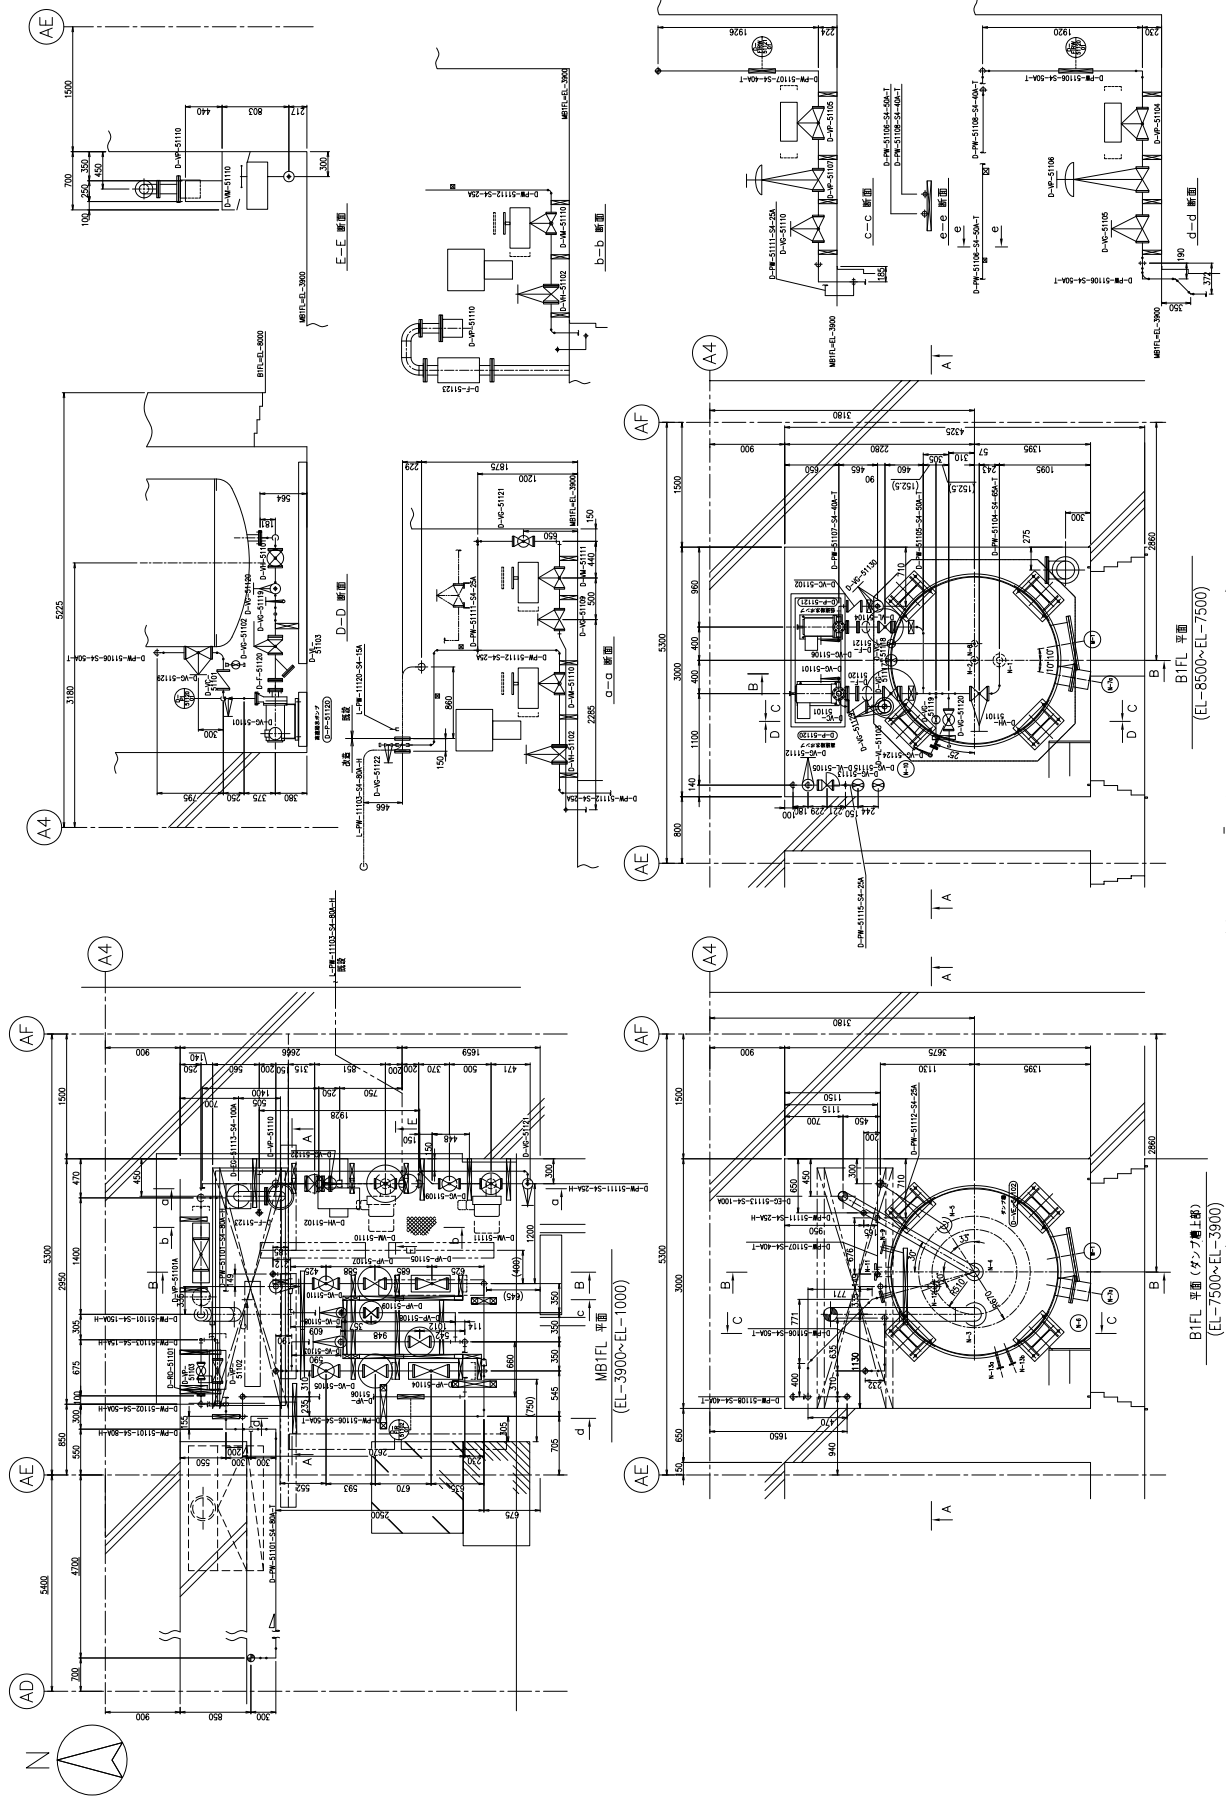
(3) 配管配置図 (炉下室 (S) 平面)
